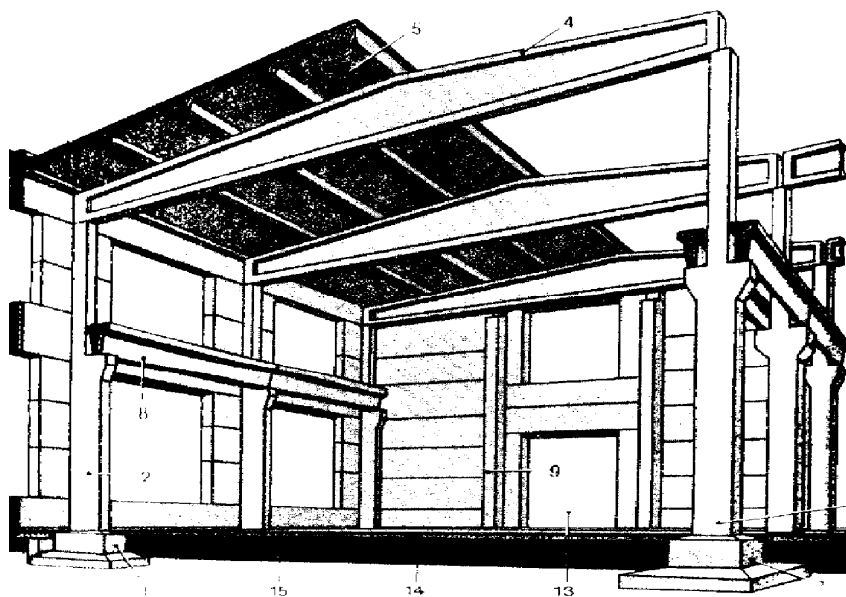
Конструктивная схема каркаса одноэтажного промышленного здания:
